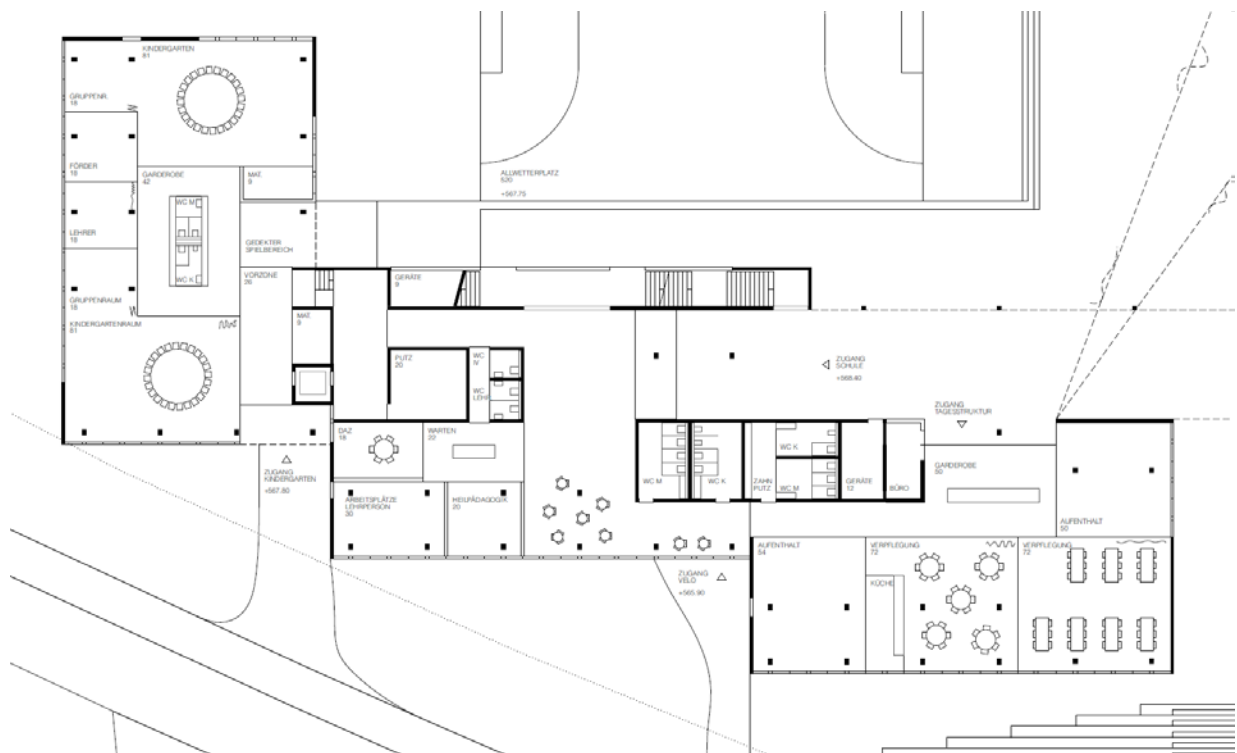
Grundriss Erdgeschoss des Siegerprojekts BILL
